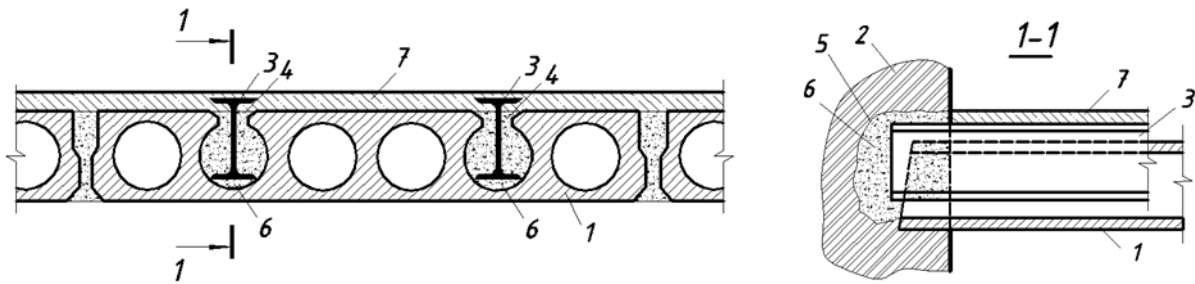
Установлення металевих двотаврових балок зверху залізобетонних плит із наступним їх бетонуванням:
